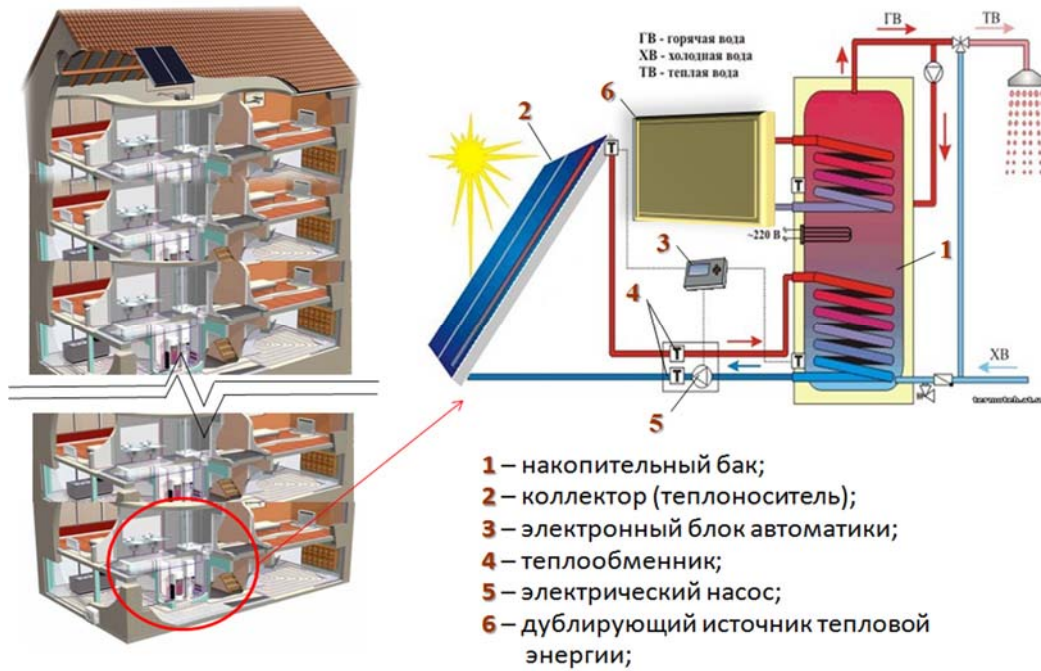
Схема горячего водоснабжения и отопления жилого дома
